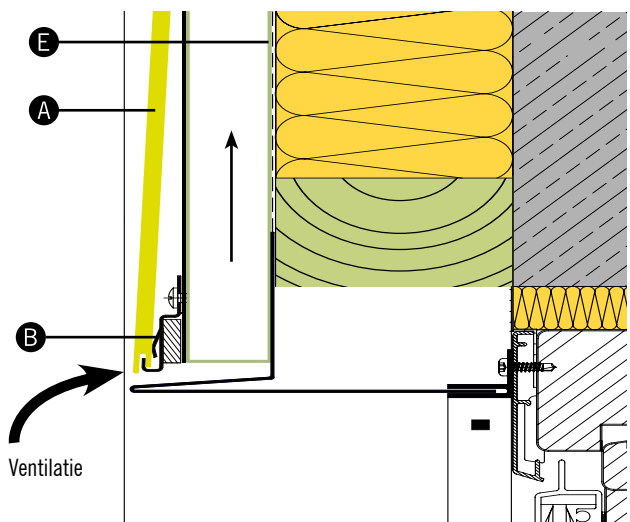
DETAILLERING: VERTICALE DOORSNEDES SYSTEEM PM04
